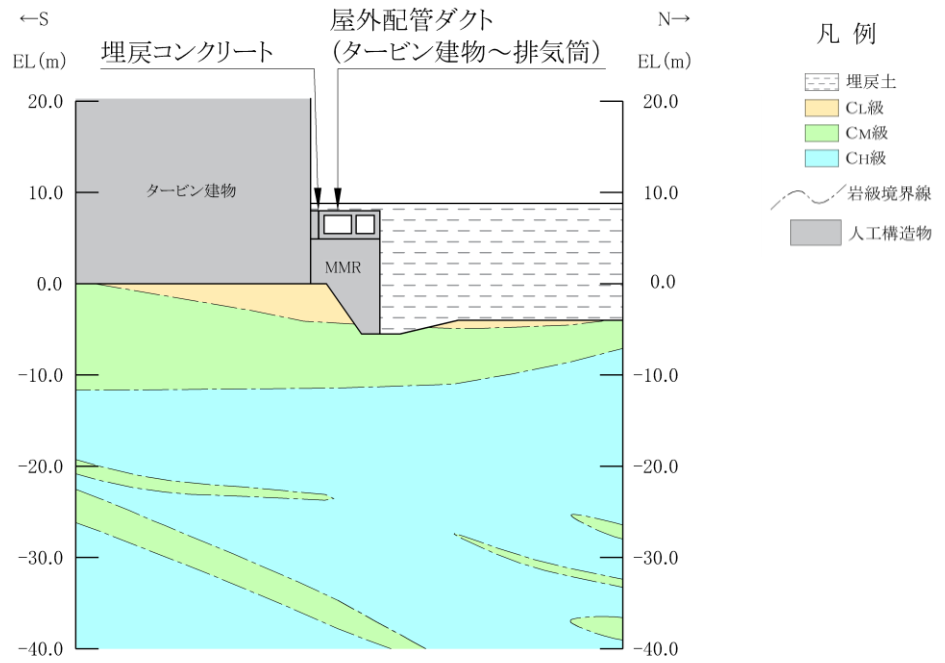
一体化部 地震時荷重算出用地質断面図 (A-A断面)
